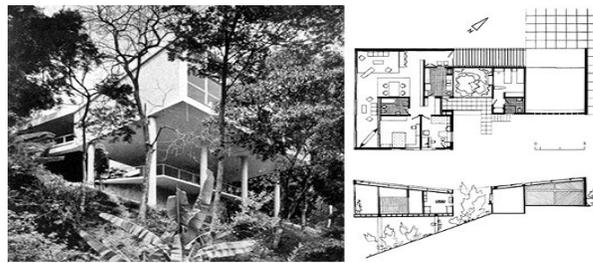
Residência de Carmen Portinho. Fachada e Planta.
